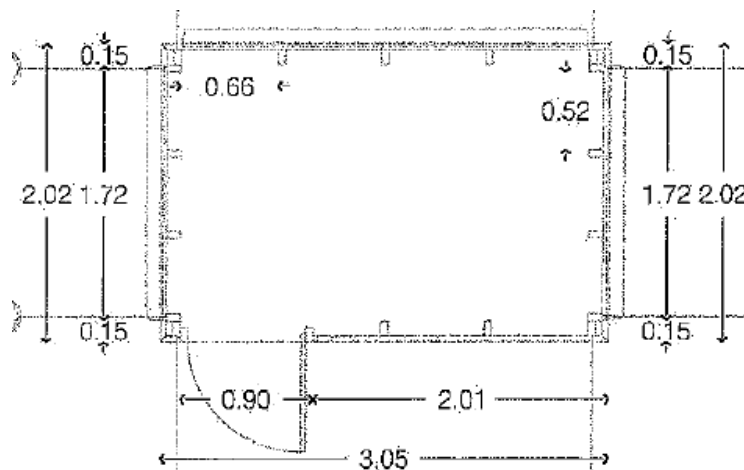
Planta constructiva guía para diseño de cocineta para Panacu (m)
